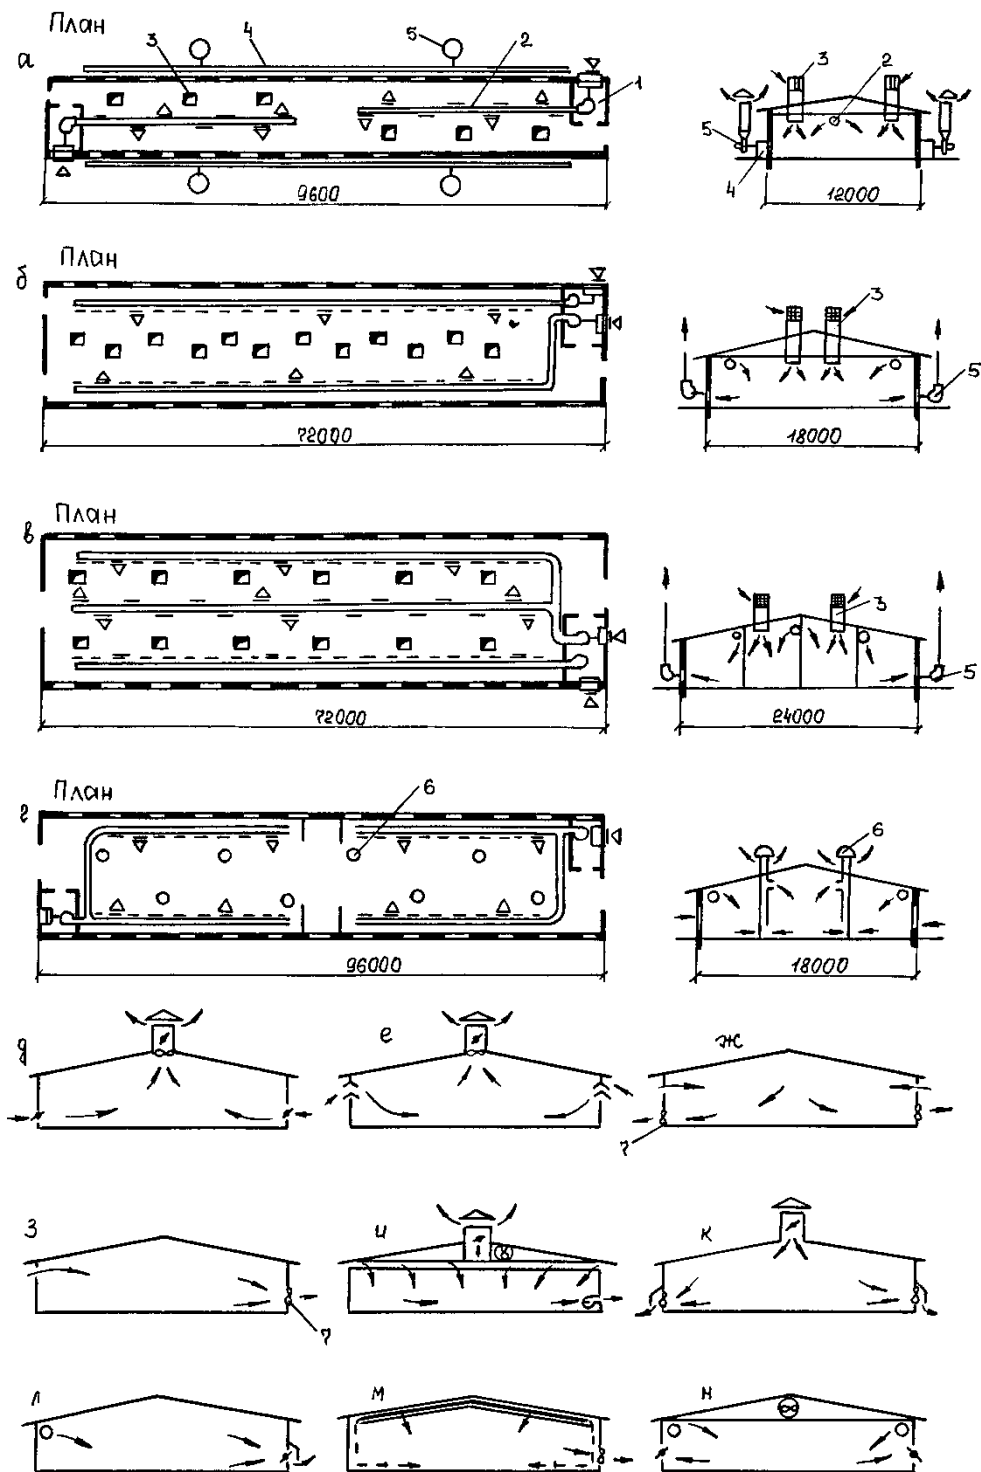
Схемы вентиляции птицеводческих помещений.
